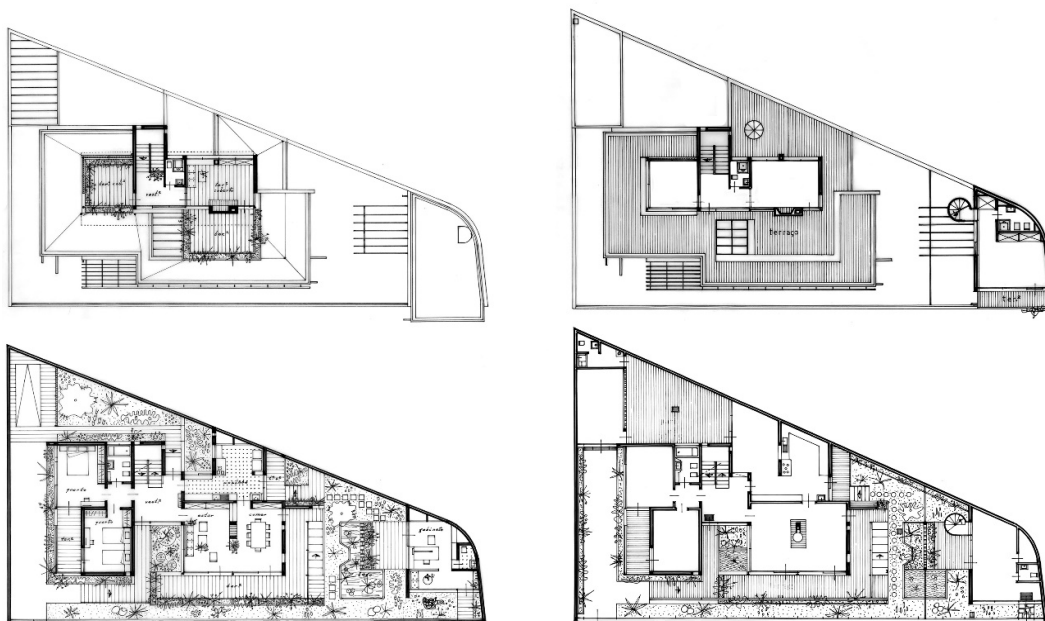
Gomes da Costa, Moradia en Faro: Planta alta (sup.) y planta baja (inf.), proyecto de 12/3/1966
